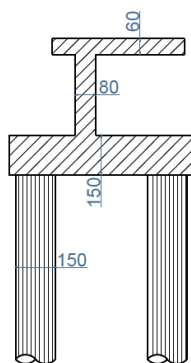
sezione verticale spalla tradizionale, quotata in cm
